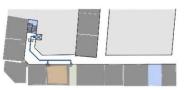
Aula 4ºB planta 1º. Mesa de profesor.
